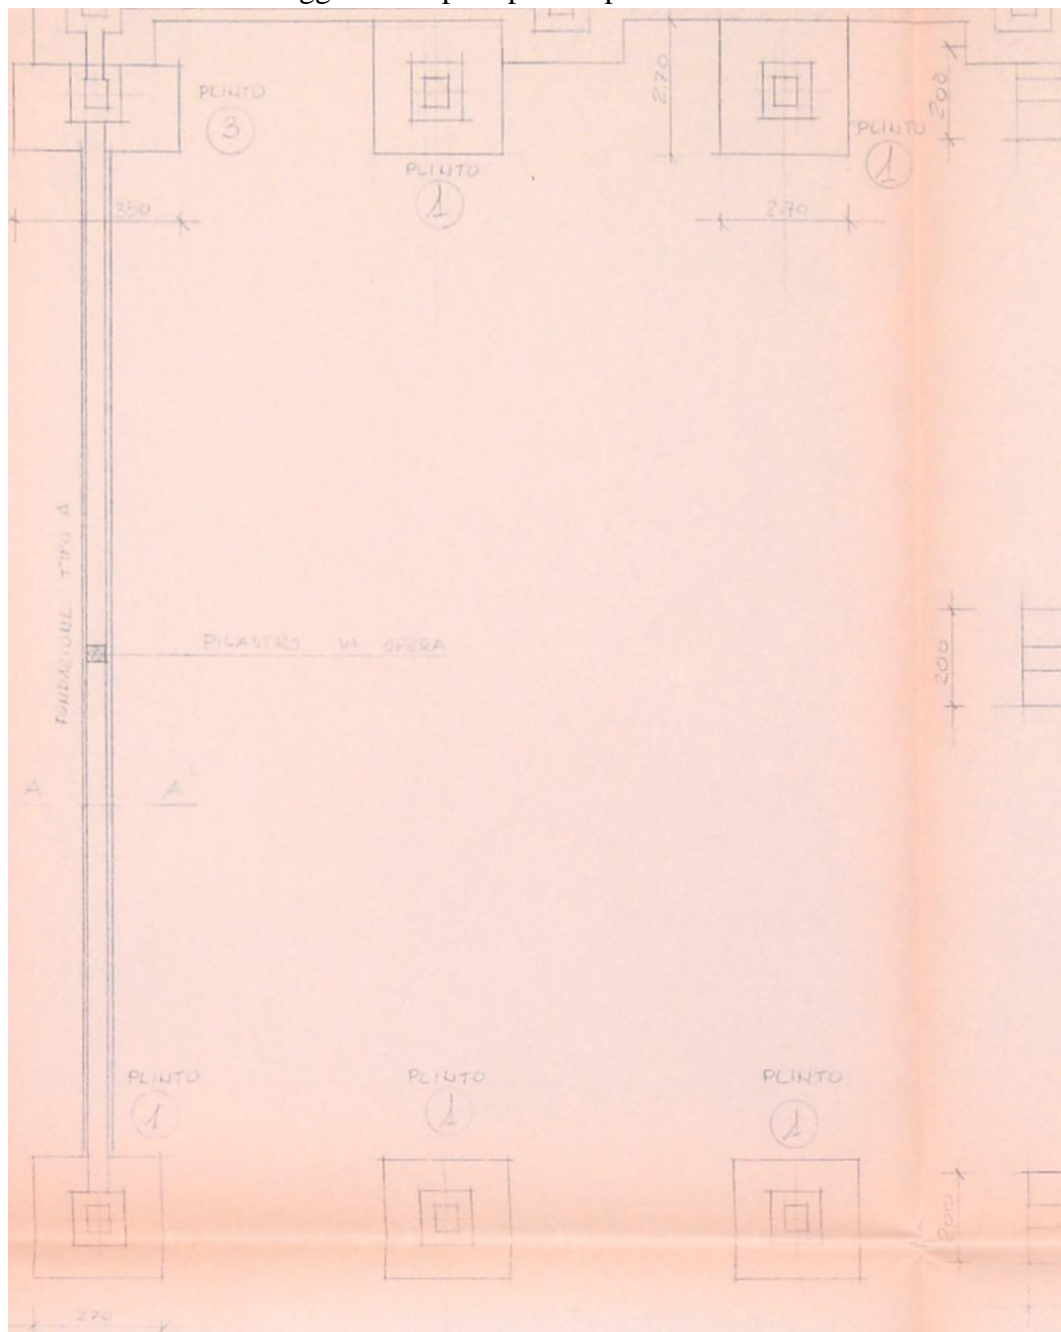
Particolare di A.1990.cap.us.T06 - Pianta delle fondazioni - Fondazioni zona monopiano - porzione M
